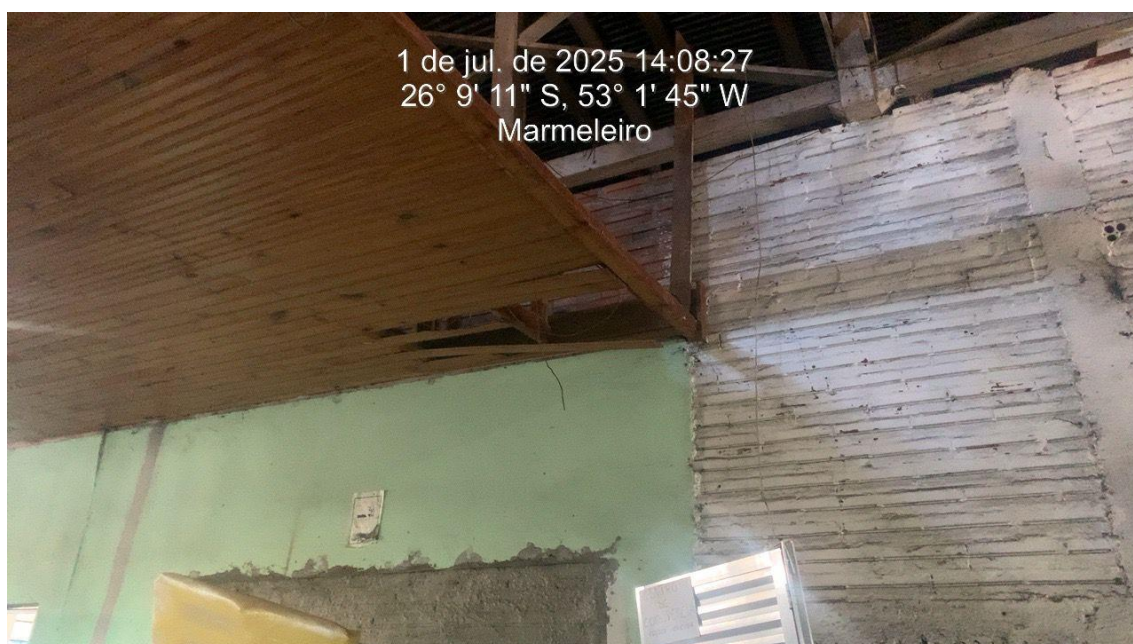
Estruturas de tesouras em madeira com grande deformação.
